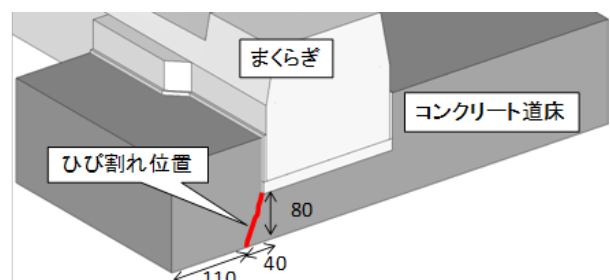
まくらぎ長手方向の荷重におけるひび割れ状況
